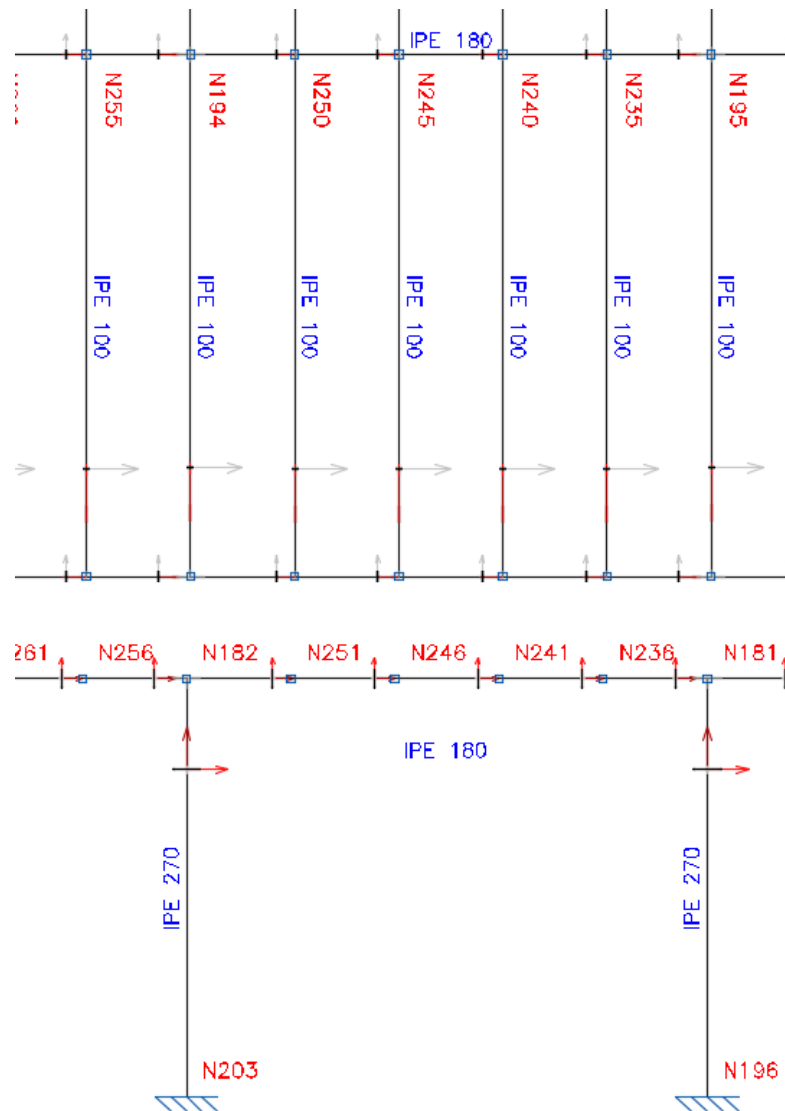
Parte del altillo con detalle de perfil de las barras y nudos
